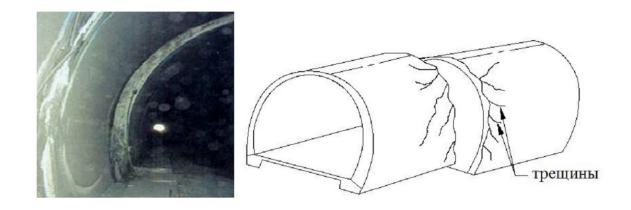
Разрушение тоннеля при сдвиге грунта в зоне разлома
